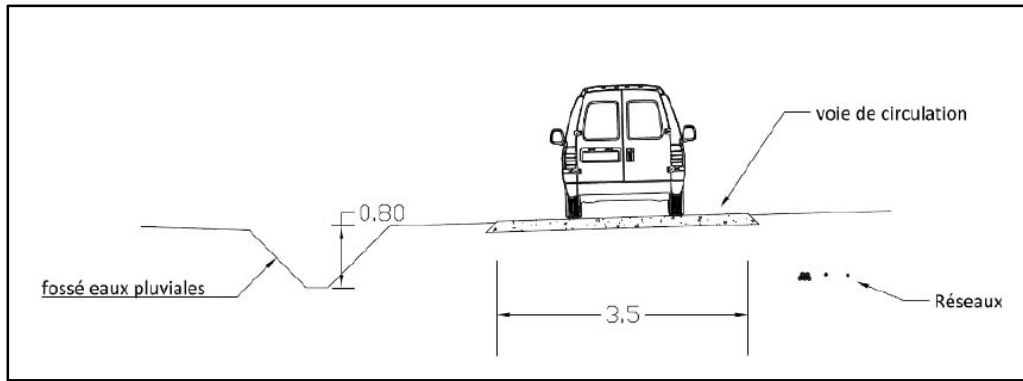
Profil en travers type des pistes de desserte de la zone du parc photovoltaïque
